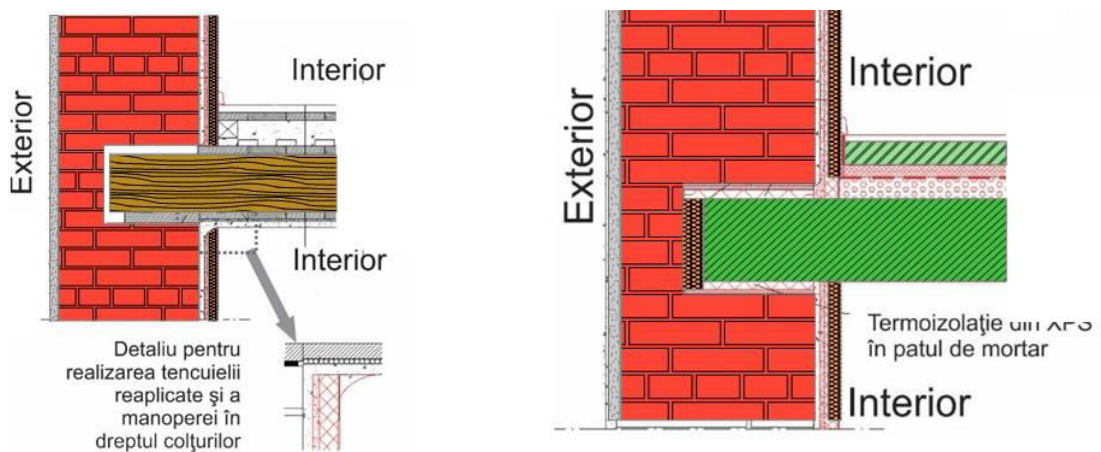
a,b - Exemplu de amplasare al pachetului termoizolator la interior în zona intersecției zidului exterior cu un planșeu a - de lemn, b - beton armat
